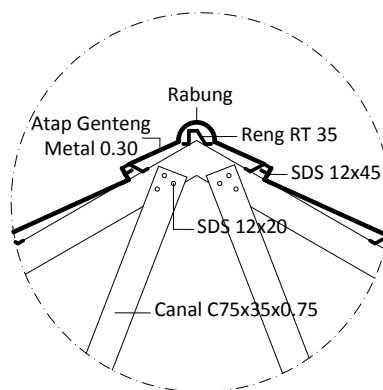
Gambar Kerja Konstruksi Baja Ringan
